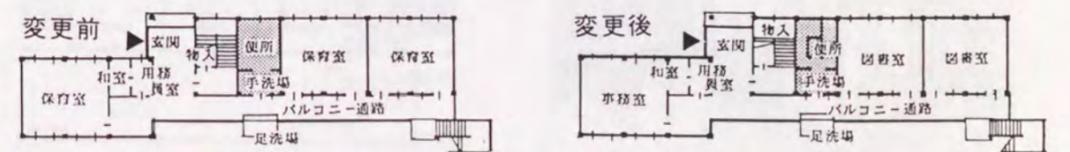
<39>守口市児童文化館(旧幼稚園)1階平面図
